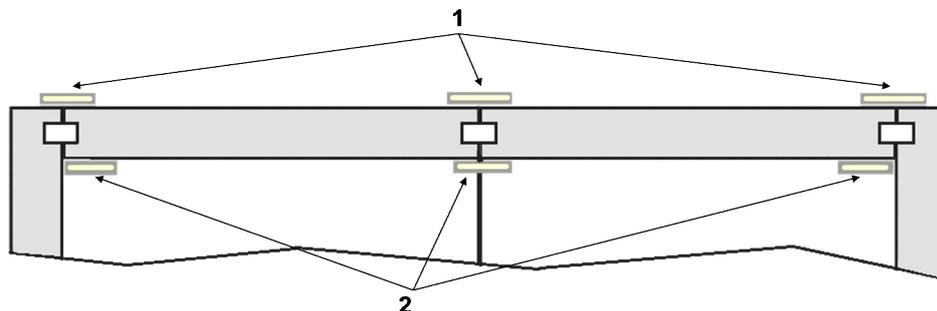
Вид сверху на пазы, подготовленные к заливке раствора:
